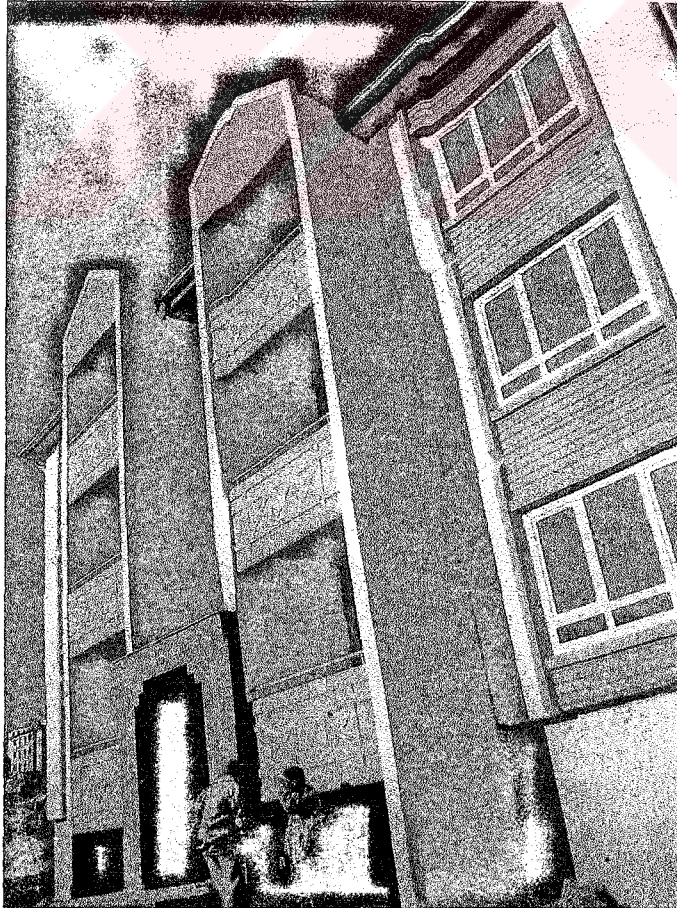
Ön cephe boyası bitmiş bir K2-1 blok görünüşü
